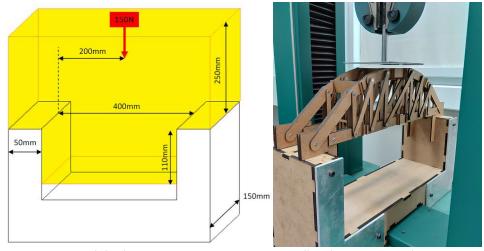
Modelo do suporte para ensaio e restrições de geometria da ponte.
